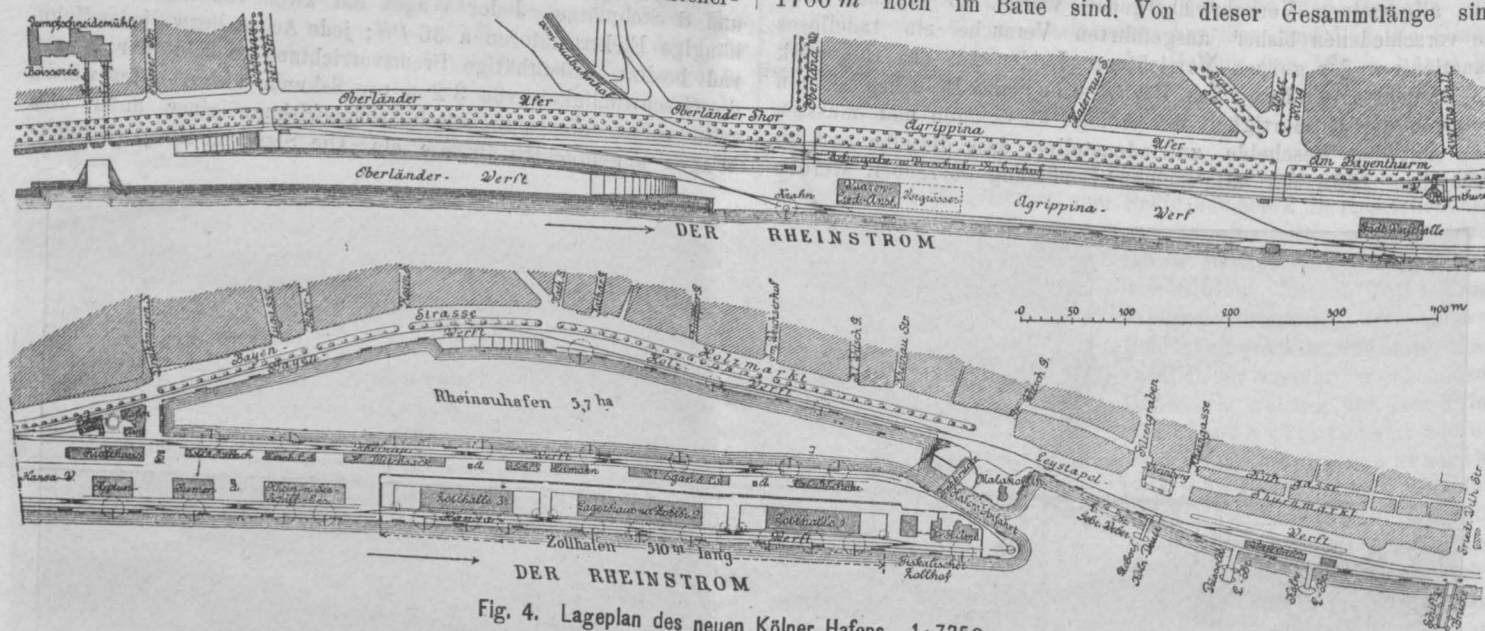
Lageplan des neuen Kölner Hafens. 1:7250.
